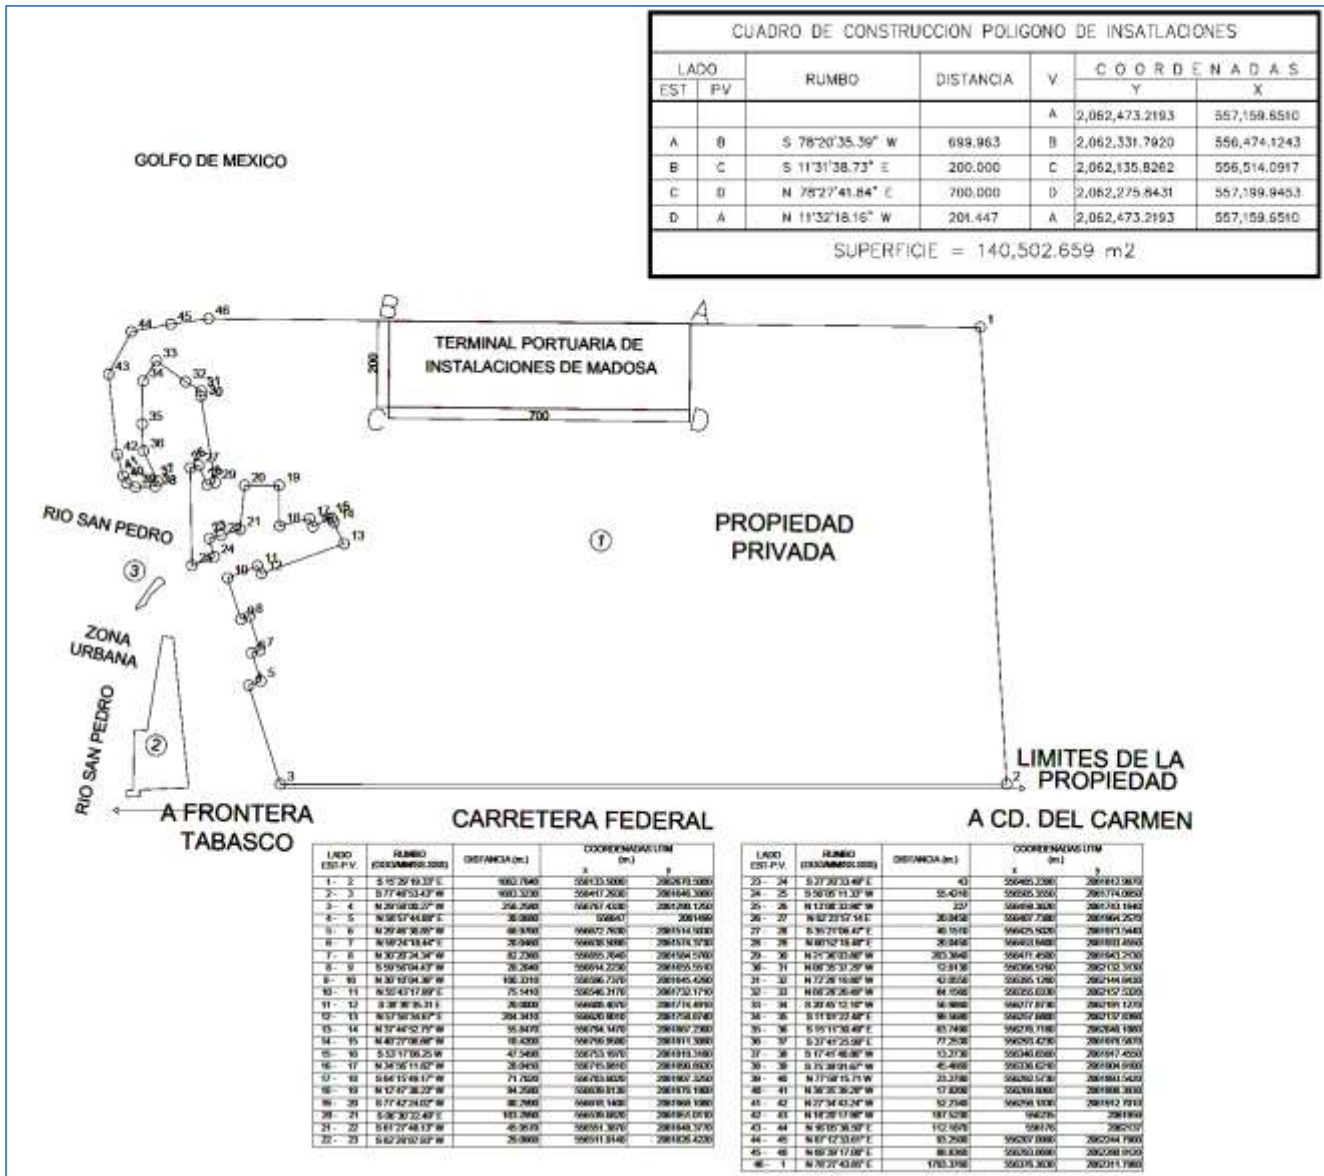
Alojamiento de las instalaciones terrestres del proyecto en el polígono de instalaciones terrestres (Arriba) y el de aplicación (abajo).
